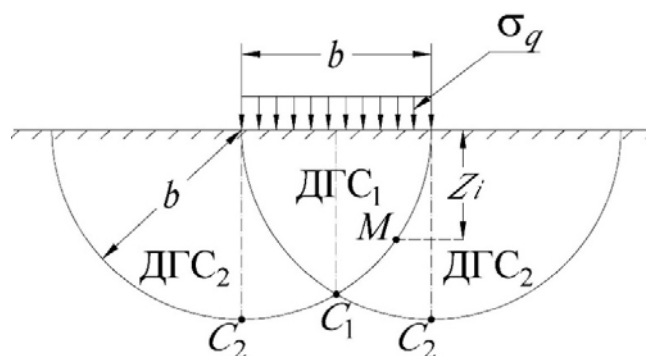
Схема расположения диссипативных геологических структур в грунтовом основании под нагрузкой от ленточного фундамента шириной b . σ_q — давление на грунтовое основание под подошвой фундамента; ДГС₁ и ДГС₂ — диссипативные геологические структуры в грунтовом основании.
